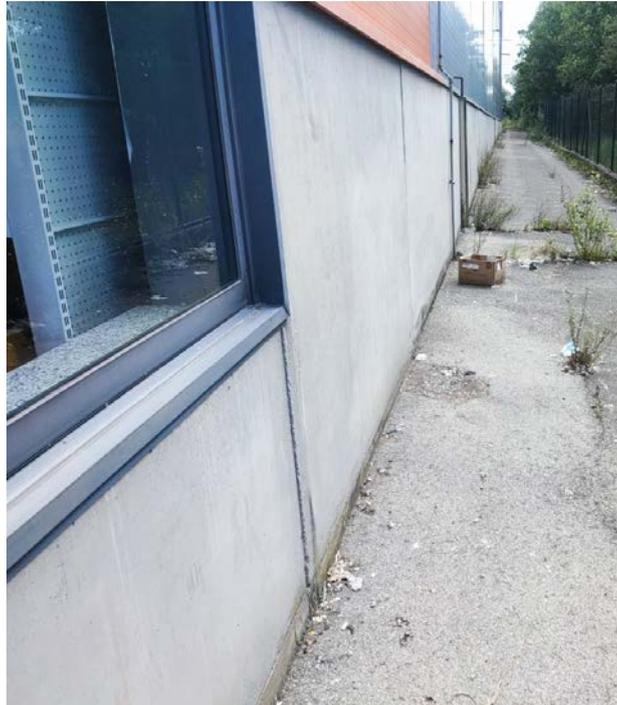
Fachada aleadaña al cauce que se propone impermeabilizar.
